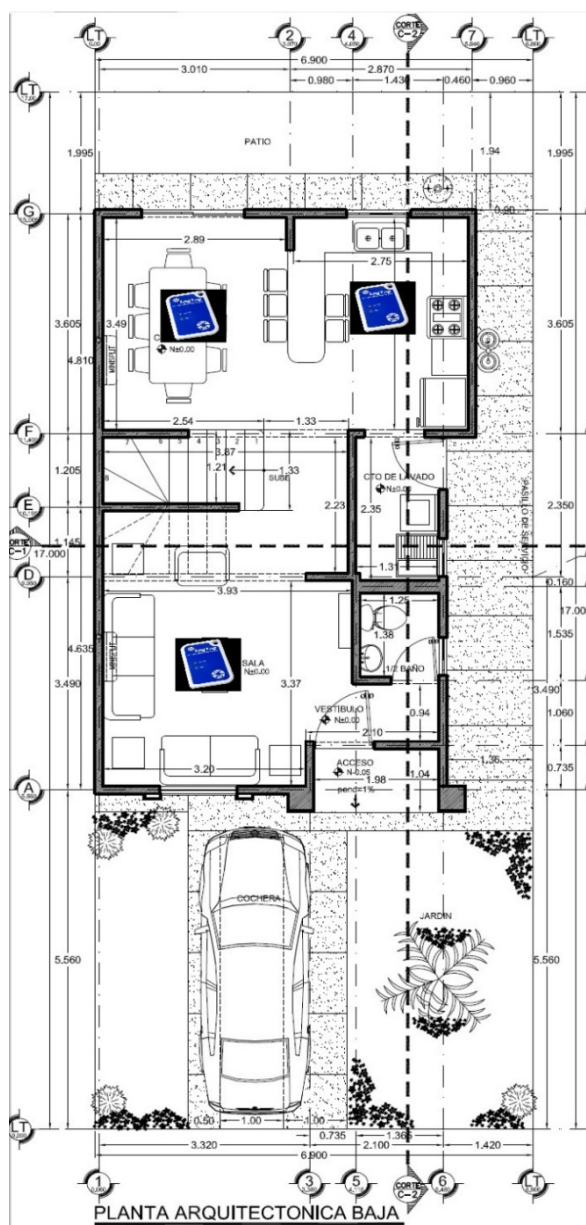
Ubicación de los sensores en la planta arquitectónica baja de la vivienda.
